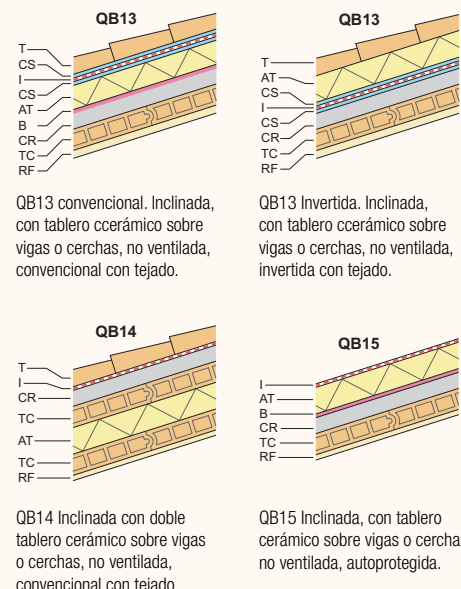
Tipos de cubiertas de tablero cerámico sobre viguetas autoportantes.
